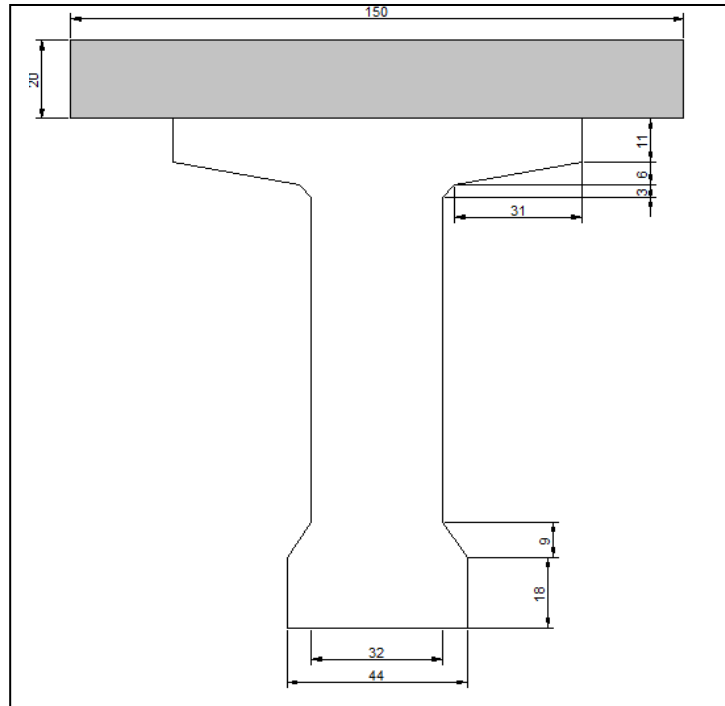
Deuxième section de la poutre en BP plus l'hourdis général.
